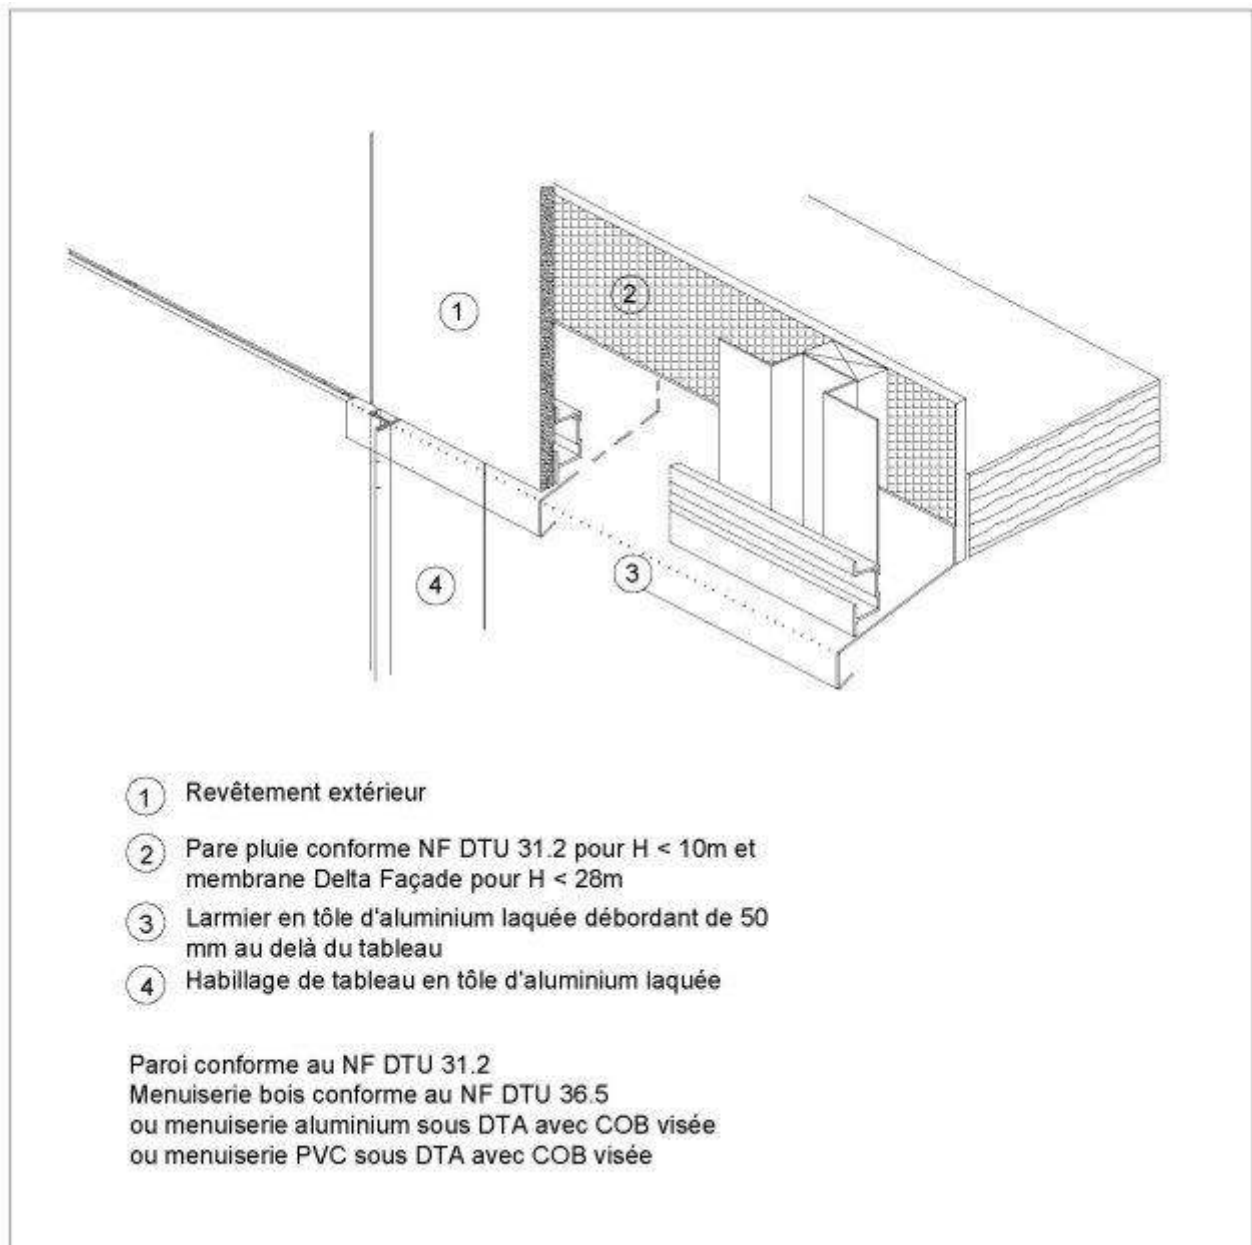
Pose sur COB – Coupe sur linteau de baie (variante)
